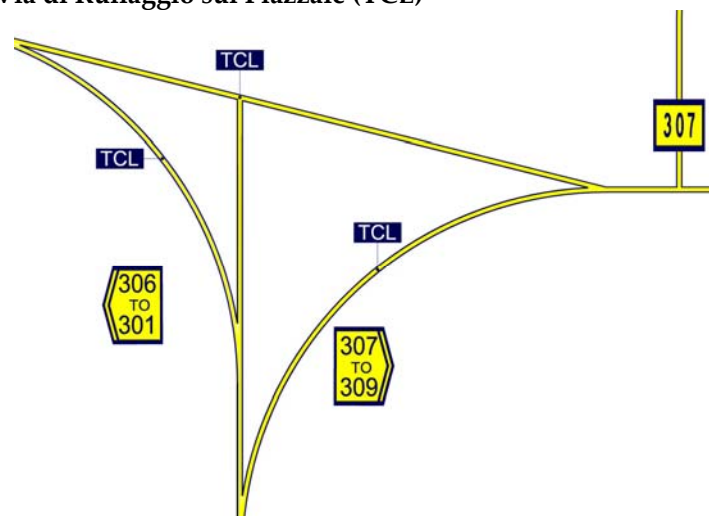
Stralcio segnaletica d'Asse della Via di Rullaggio sul Piazzale
